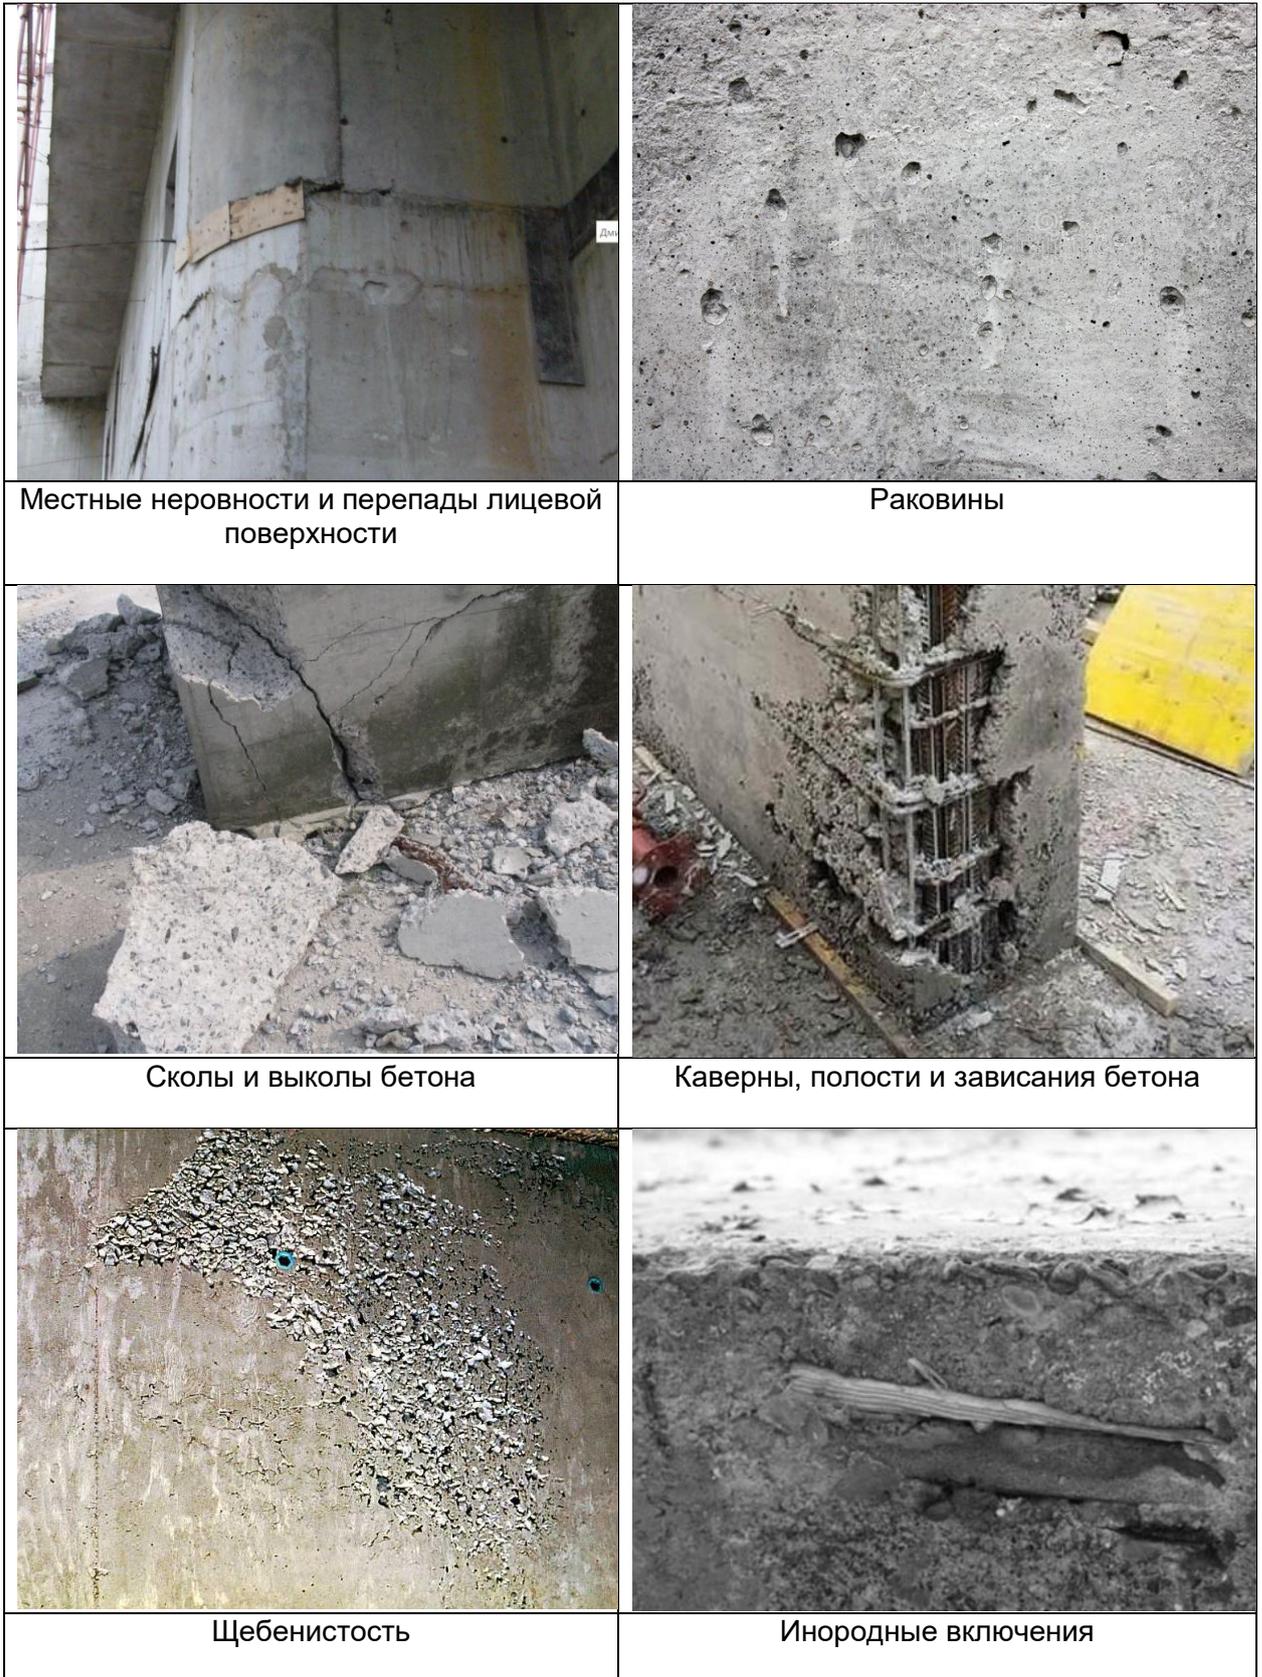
Характерные дефекты при возведении железобетонных конструкций.
